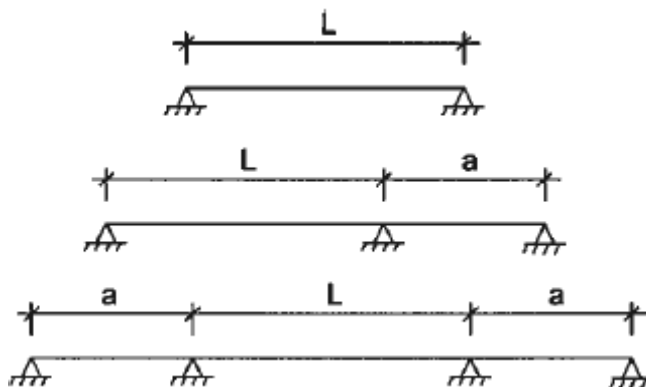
Esquemas estruturais do tipo de ponte.
